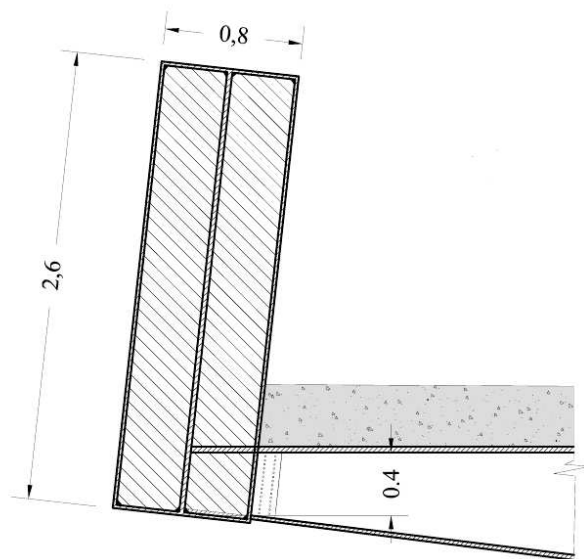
Detalle enlace vigas transversales y vigas laterales rigidizadas. Solución inicial.
